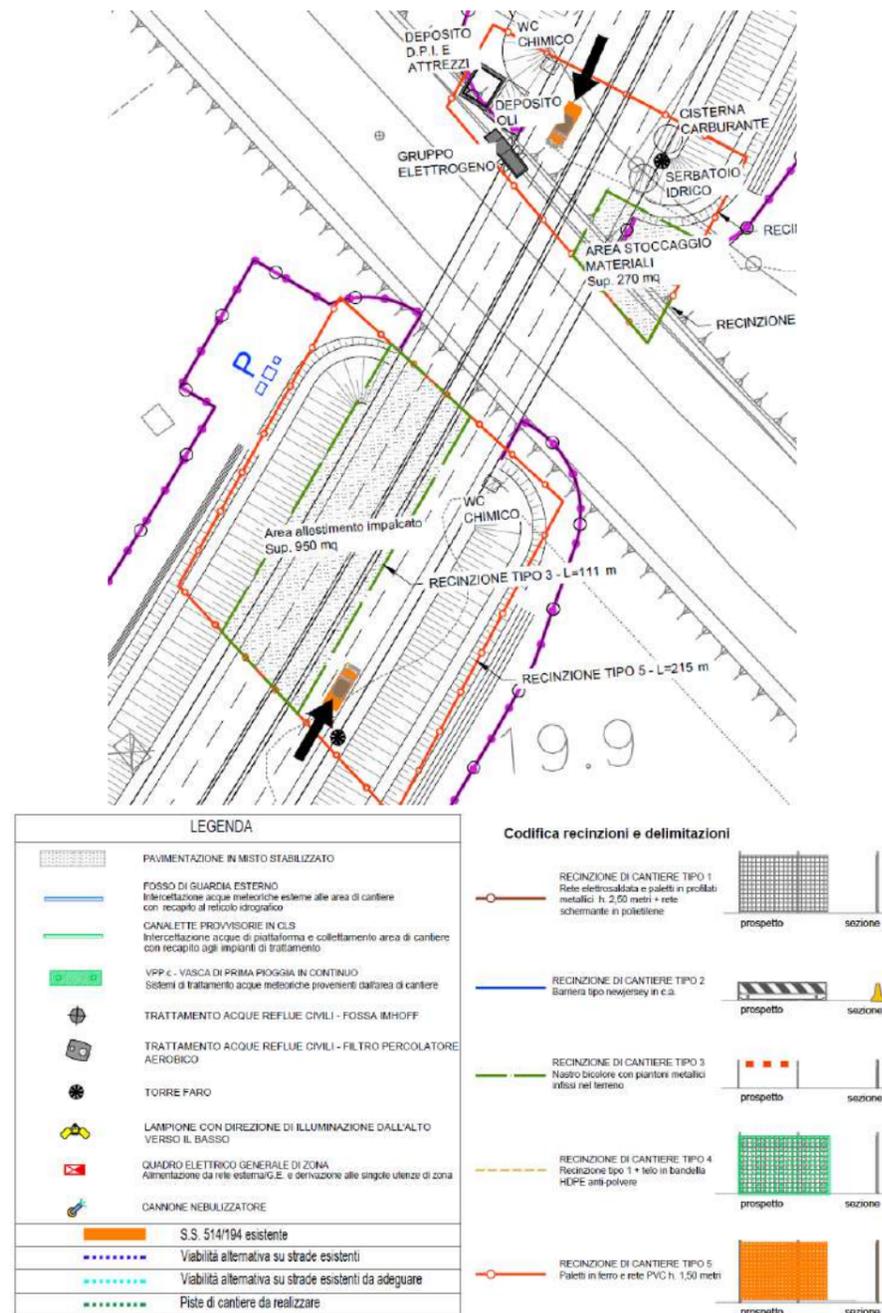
Planimetria del cantiere operativo CA.V.18.
